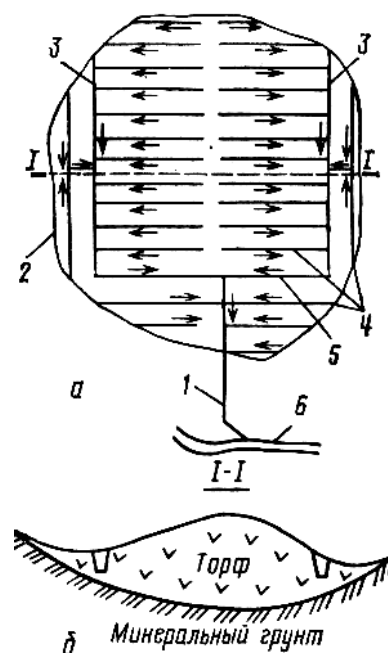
Схема осушения верхового болота для добычи торфа: а – план, б – профиль; 1 – магистральный канал; 2 – граница промышленной залежи торфа; 3 – валовый канал; 4 – картонные каналы; 5 – соединительный канал; 6 – водоприемник
